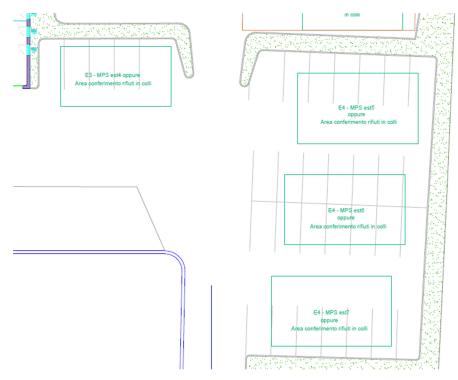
Planimetria delle aree esterne di stoccaggio E3 ed E4 allo stato di progetto
